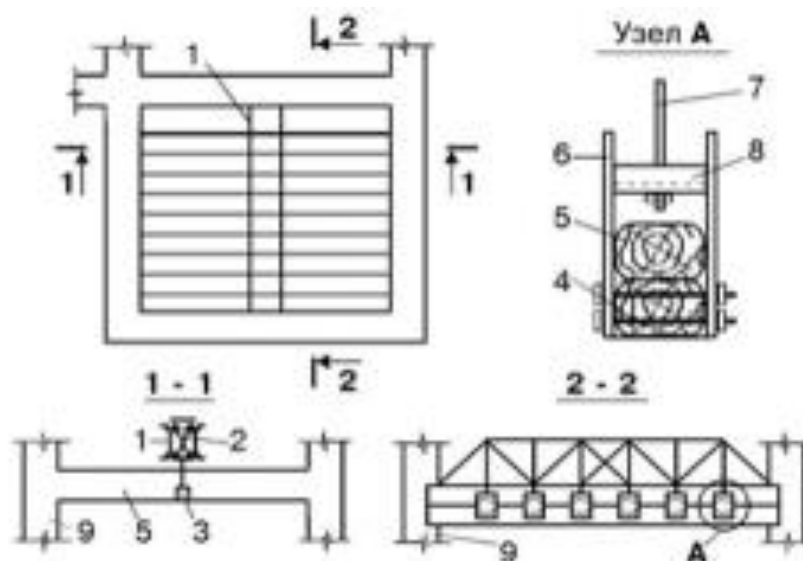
Изменение схемы работы: 1 – металлическая ферма; 2 – крестовая связь; 3 – элемент подвески балки (узел А); 4 – стяжные болты; 5 – усиливаемая балка; 6 – металлический тяж; 7 – металлические накладки; 8 – швеллер; 9 – существующие стены
